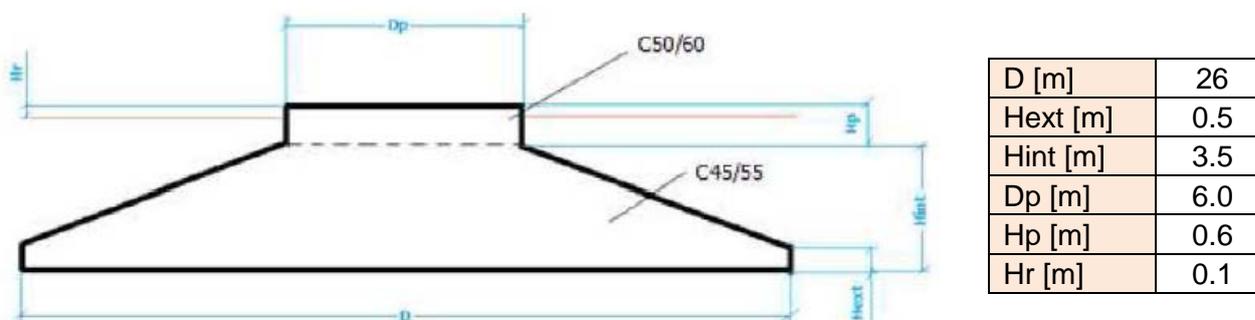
Tipico fondazione dell'aerogeneratore Siemens Gamesa SG170
